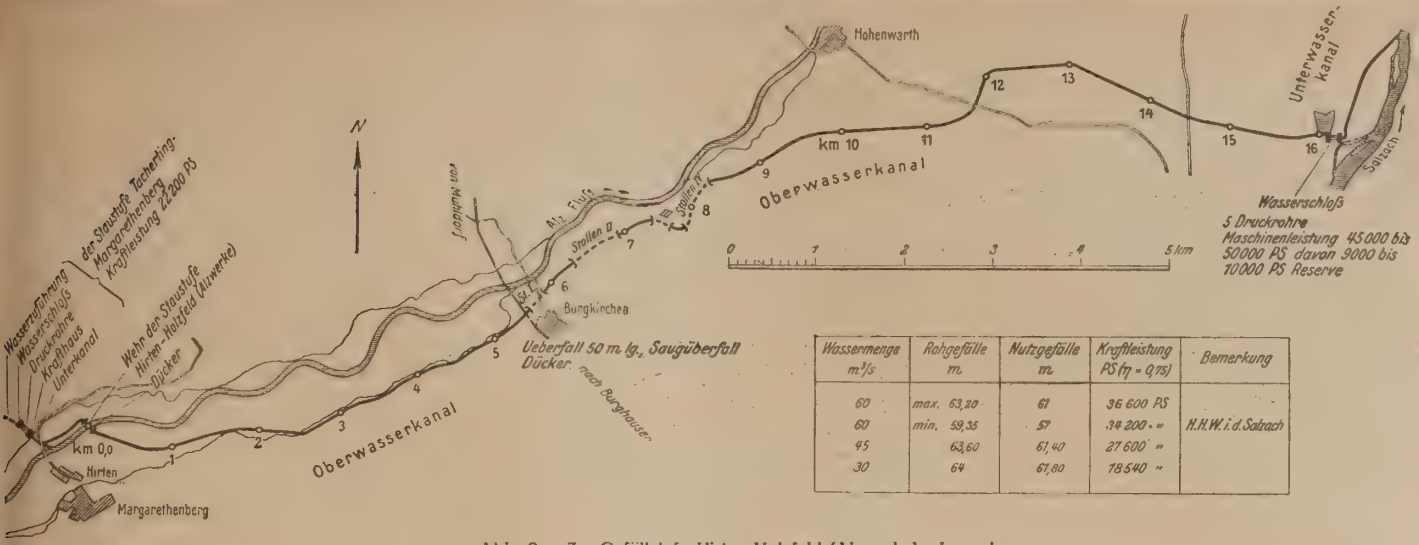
u. 3. Gefällstufte Hirten-Holzfeld (Alzwerke). Lageplan.
